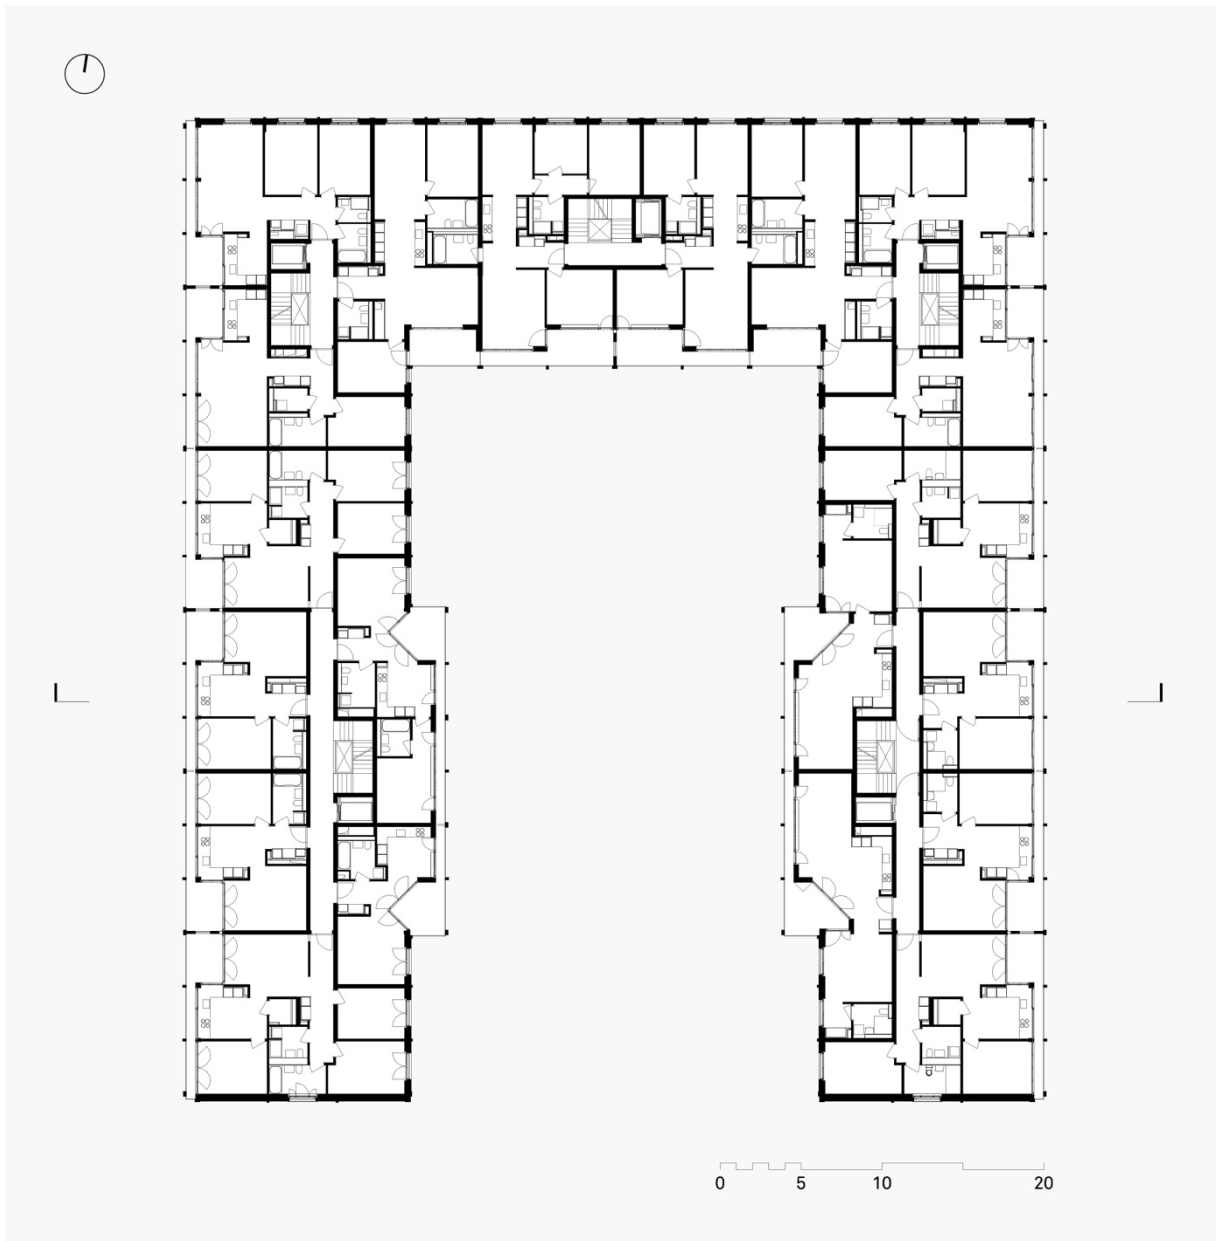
Grundriss Regelgeschoss 2. OG
